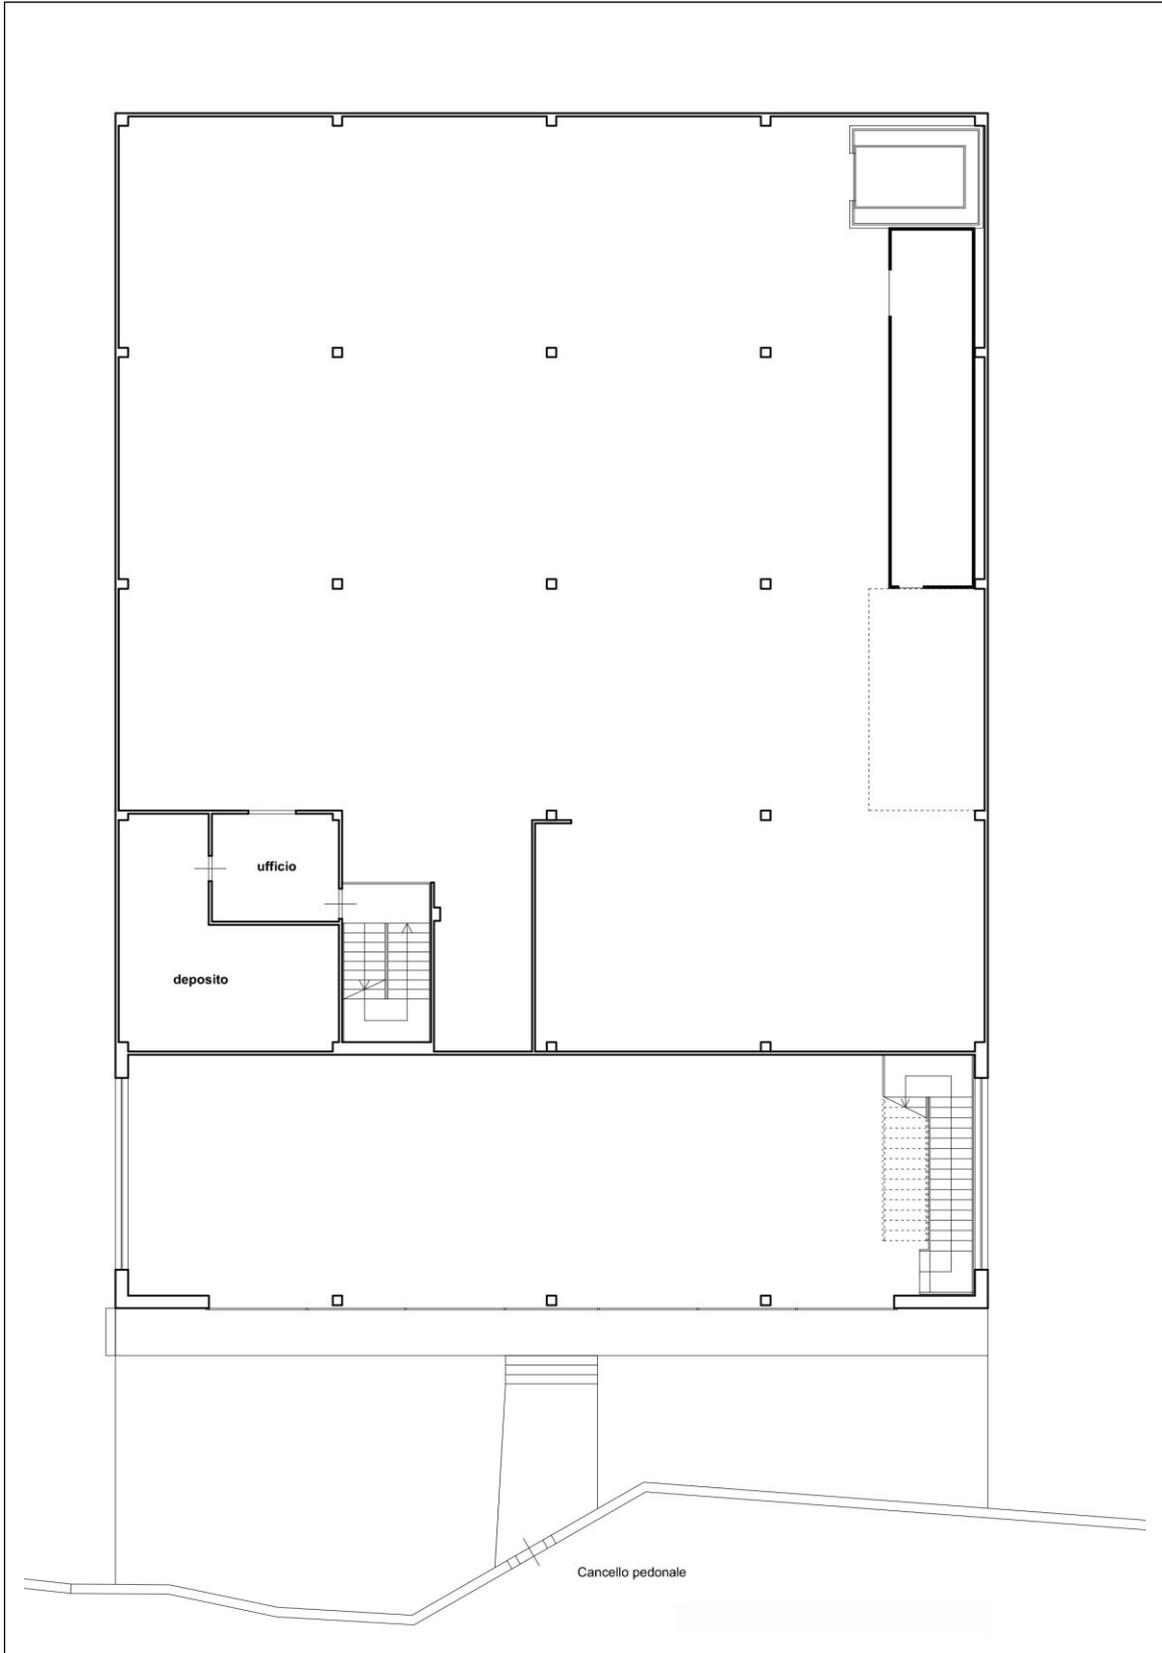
Rilievo dell'immobile pignorato. Piano ammezzato.
